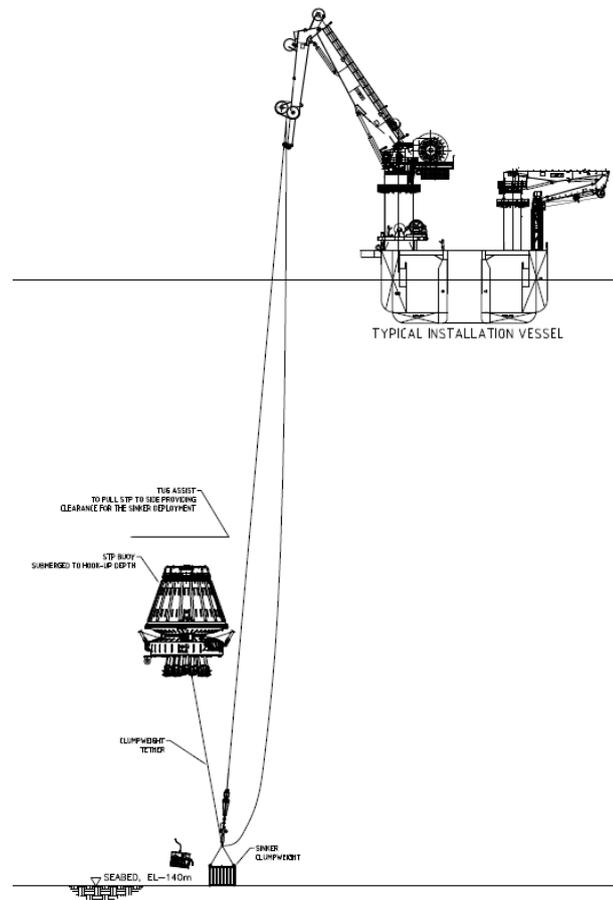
Submersão da boia STP para fixação das amarras.
